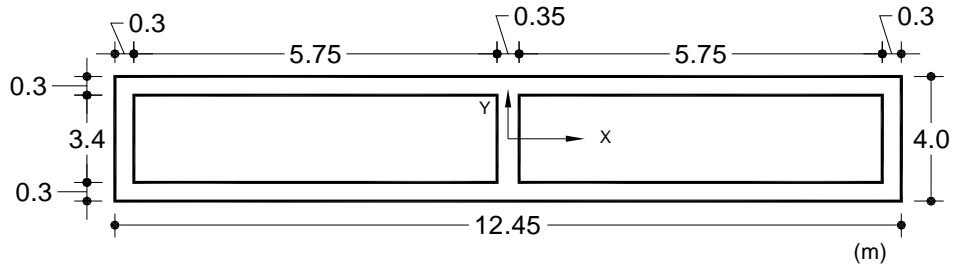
Sección 3 de las columnas 5, 6, 7 y 8. (No. 8)
